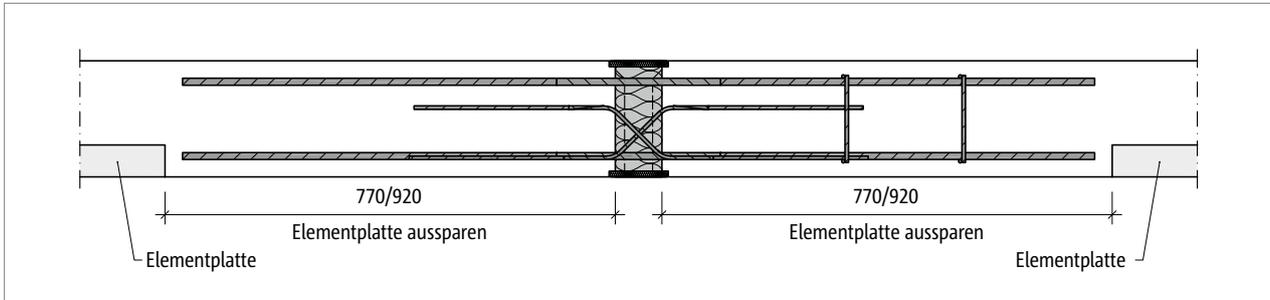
Schöck Isokorb® T Typ DP: Ausgesparte Elementdecke mit eingesetztem Isokorb® T Typ DP
